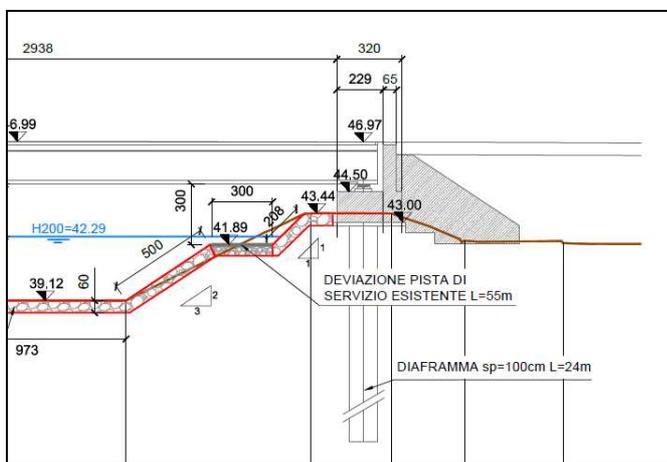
PARTICOLARE DELLE DIFESE SPONDALE PREVISTE SOTTO L'OMBRA DEL PONTE
